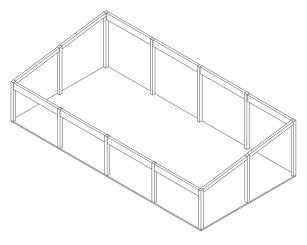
Axonometría estructural tipo 1_2 Fuente: Autores, 2024
